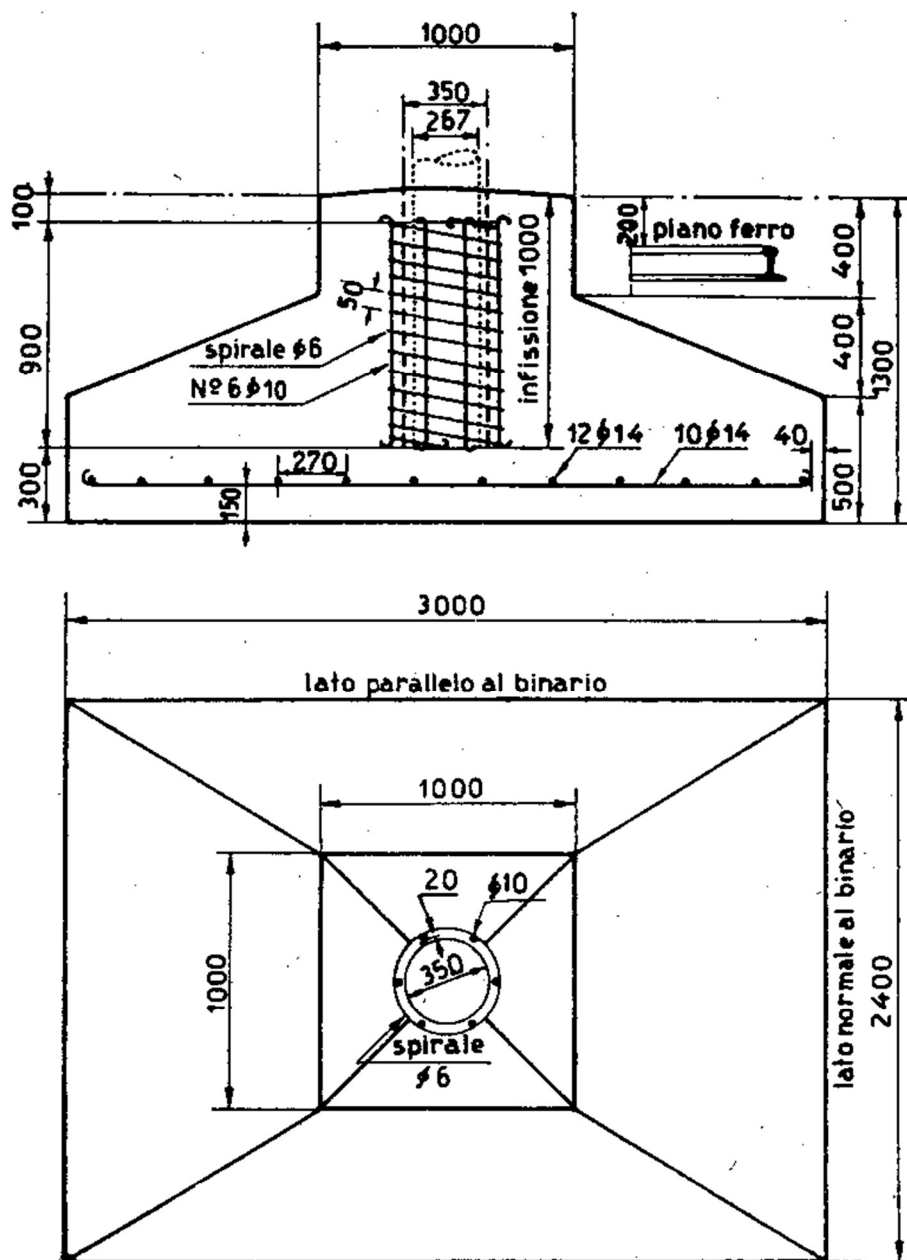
Blocco di fondazione armato per terreni poco consistenti
